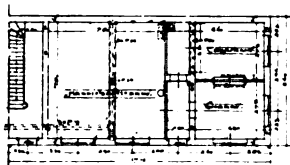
Dienstgebäude. Münsterstrasse. Erdgeschoss. 1:500.
